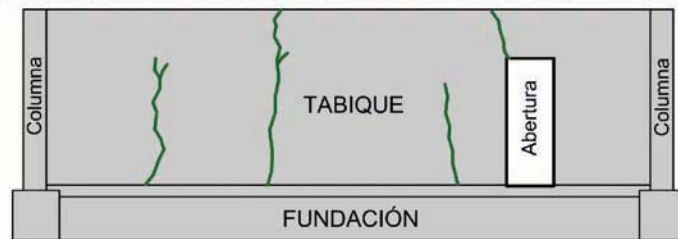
Esquemas típicos de fisuración en losas y tabiques
